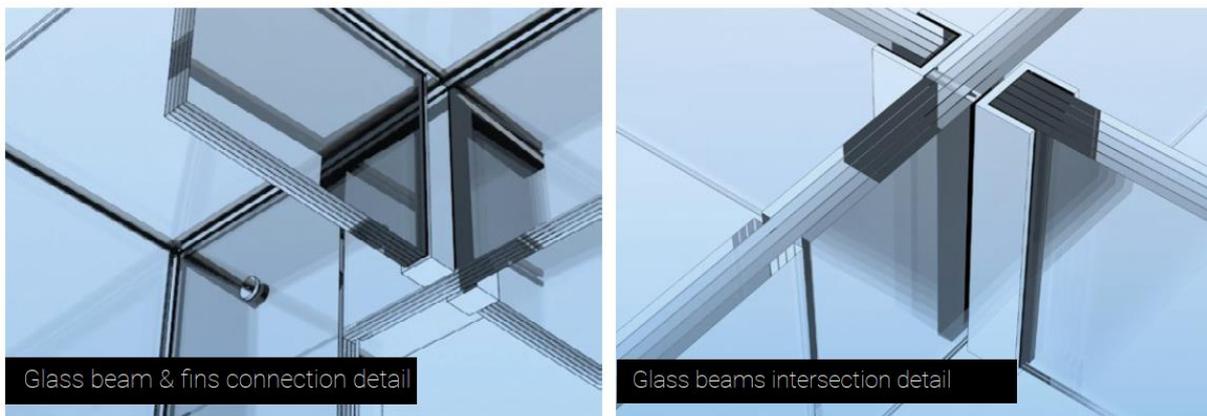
Detail der Anschlüsse: Glasträger und Lamellen (rechts) und Knotenpunkt zw. Glasträgern [36]
